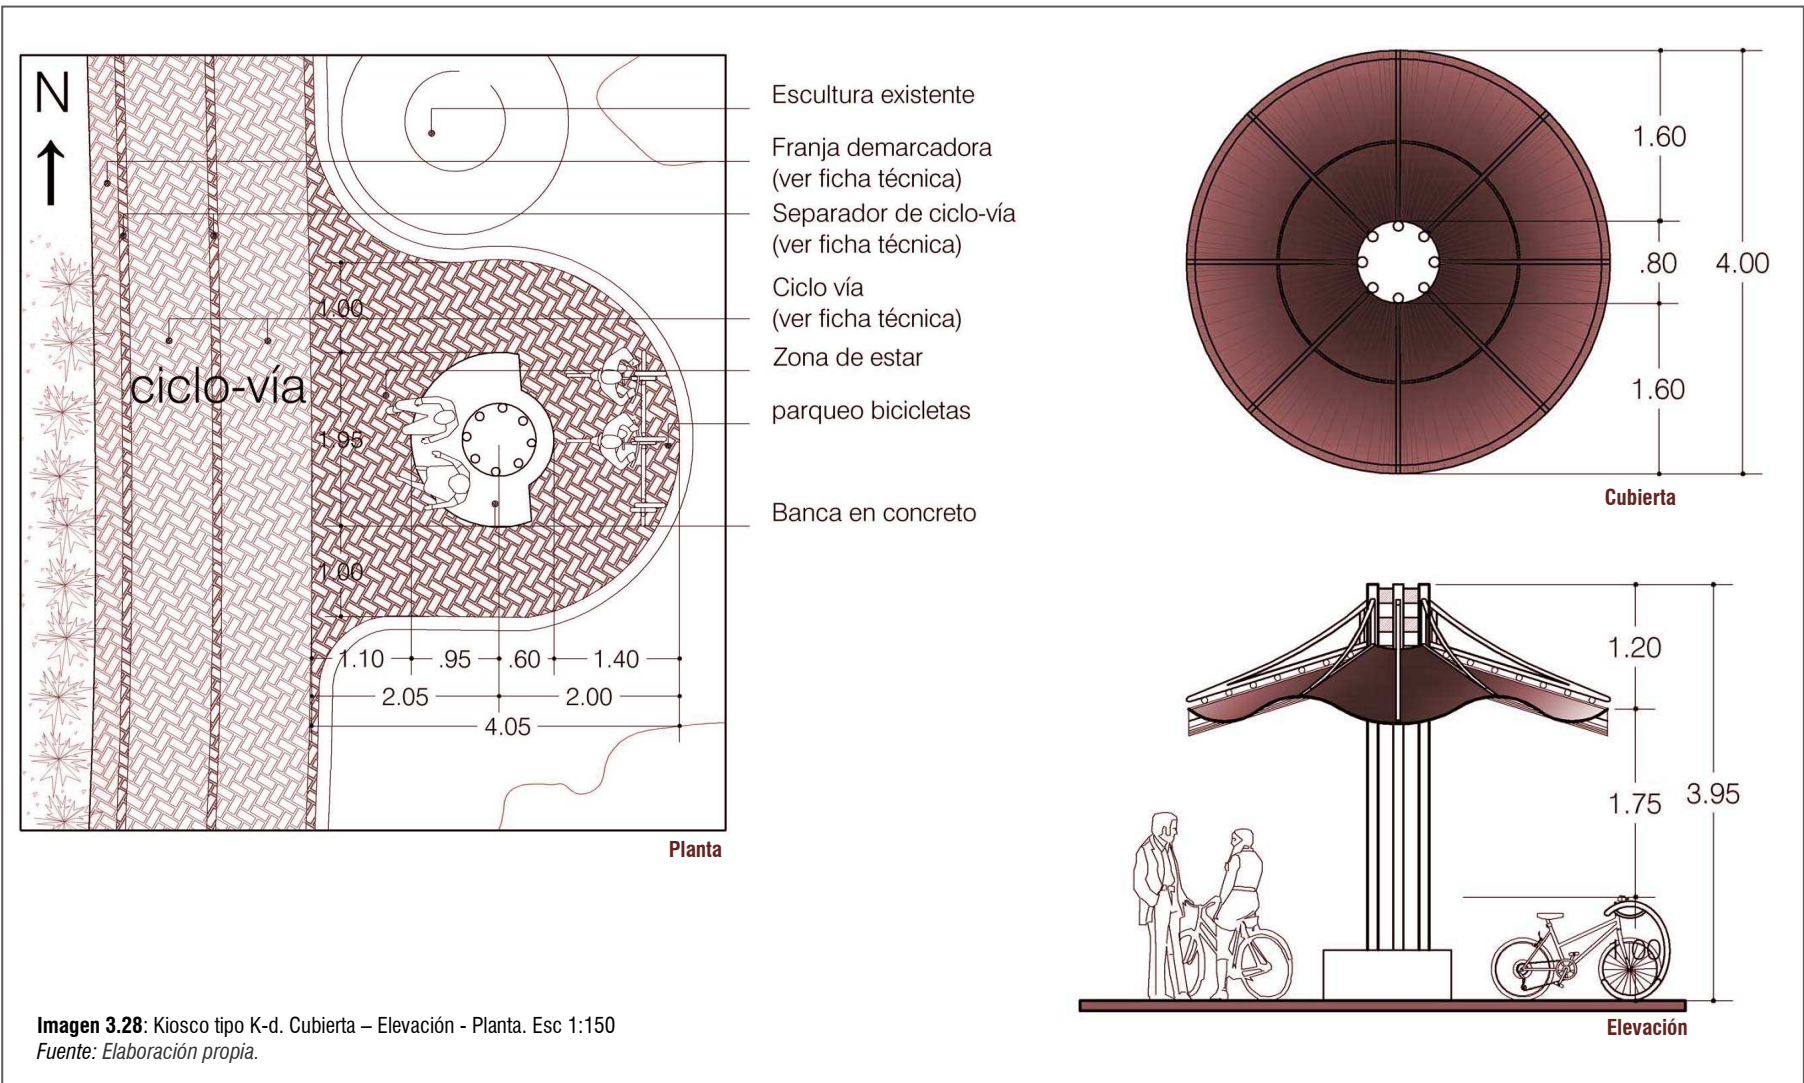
Kiosco tipo K-d. Cubierta – Elevación - Planta. Esc 1:150
